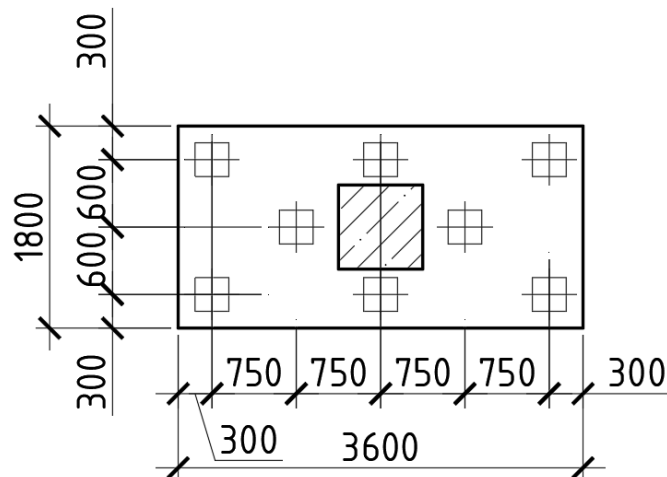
Схема расположения свай под фрагмент плитного фундамента
